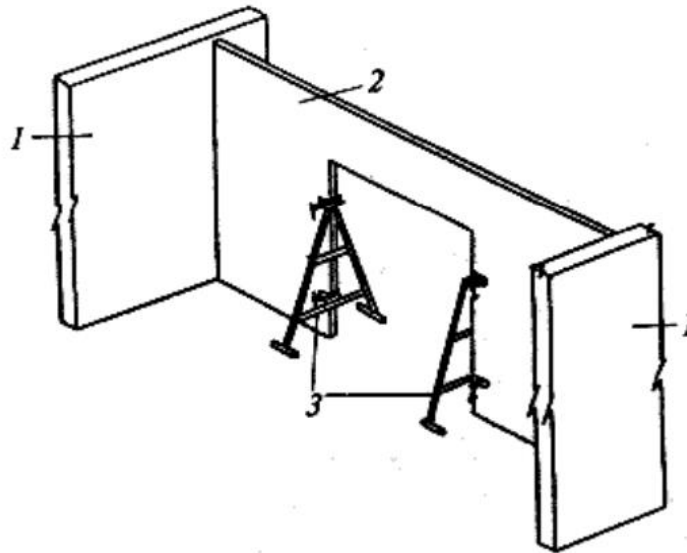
Схема тимчасового кріплення залізобетонної перегородки:
